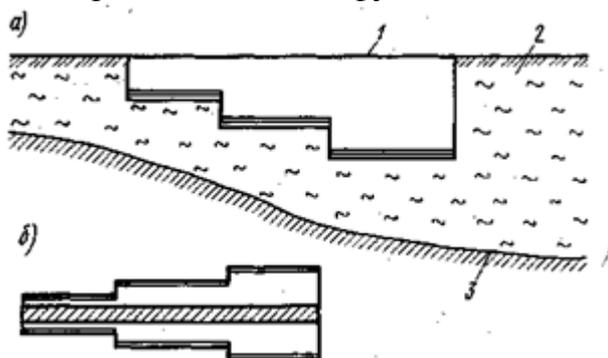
Выравнивание осадок: 1 — фундамент; 2 — сильнодеформируемый грунт; 3 — малодеформируемый грунт
